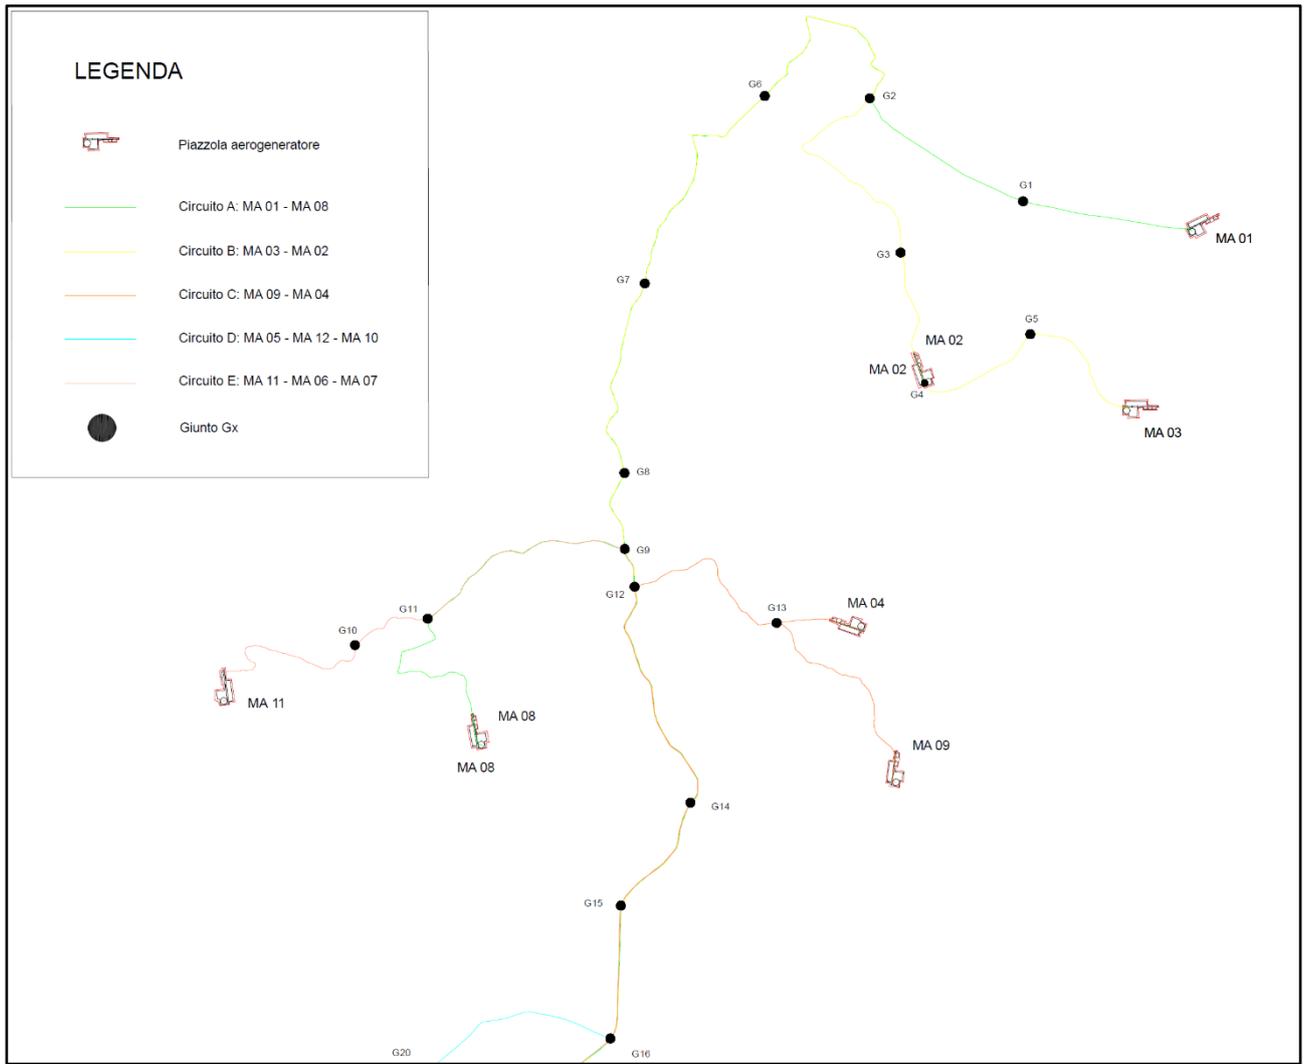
Dettaglio 1 - planimetria di distribuzione linee a 33 kV di collegamento tra gli aerogeneratori
